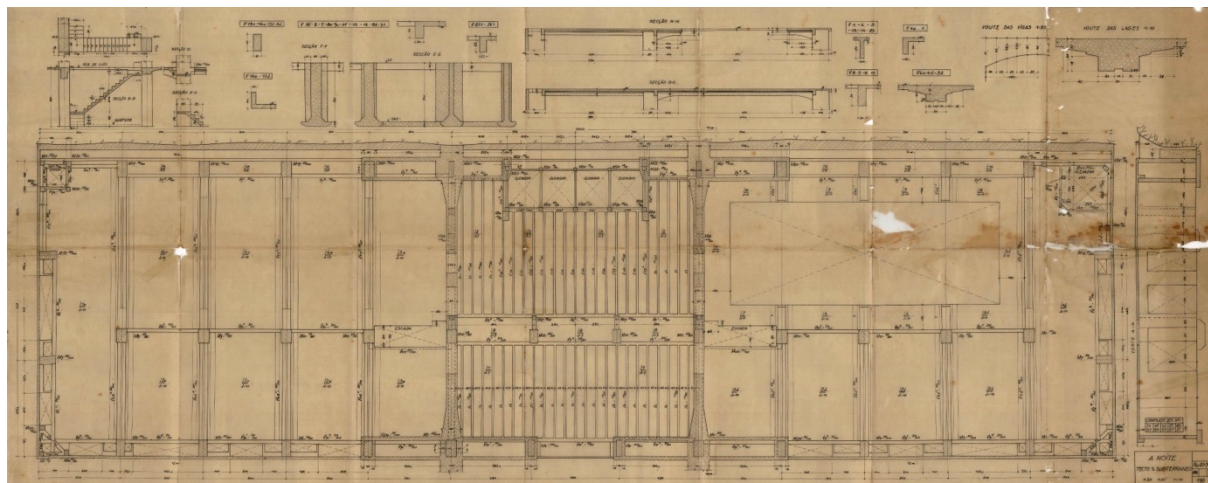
Planta estrutural do Teto do Subsolo. FONTE: SEEBLA, 2014.
